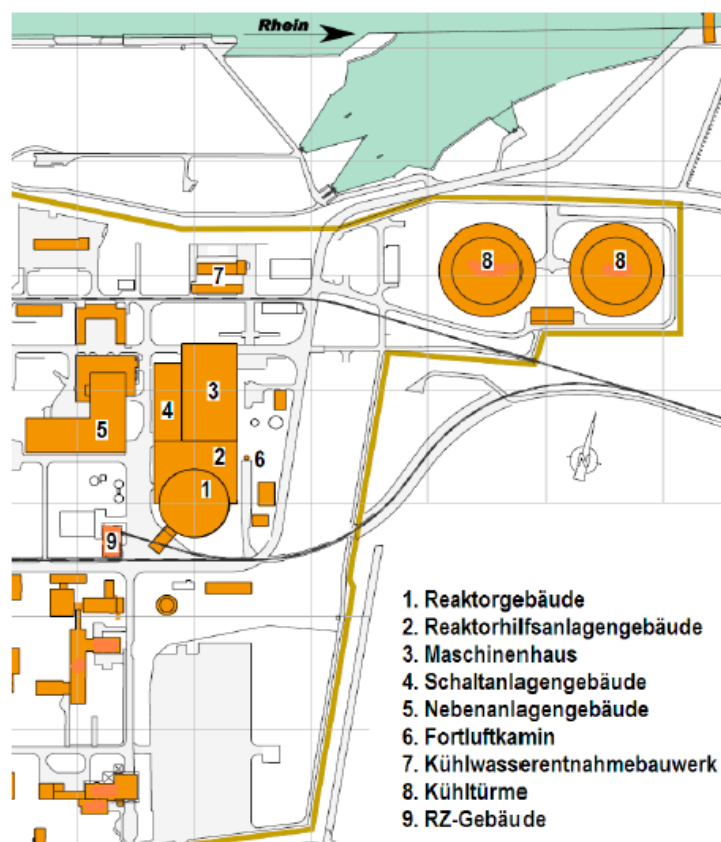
Ausschnitt des Lageplans Kraftwerk Biblis (aus /A-3/)
